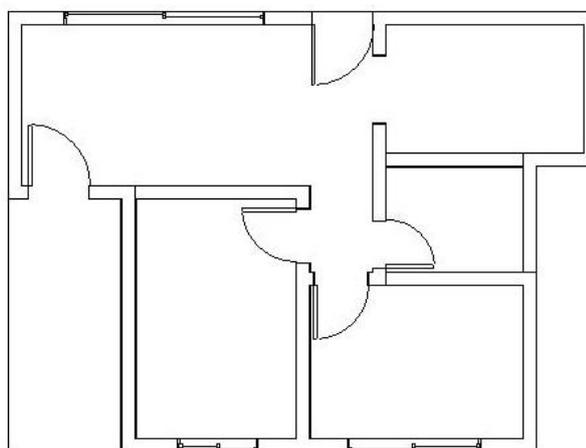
Planta Baixa - Paredes, Piso e Esquadrias
